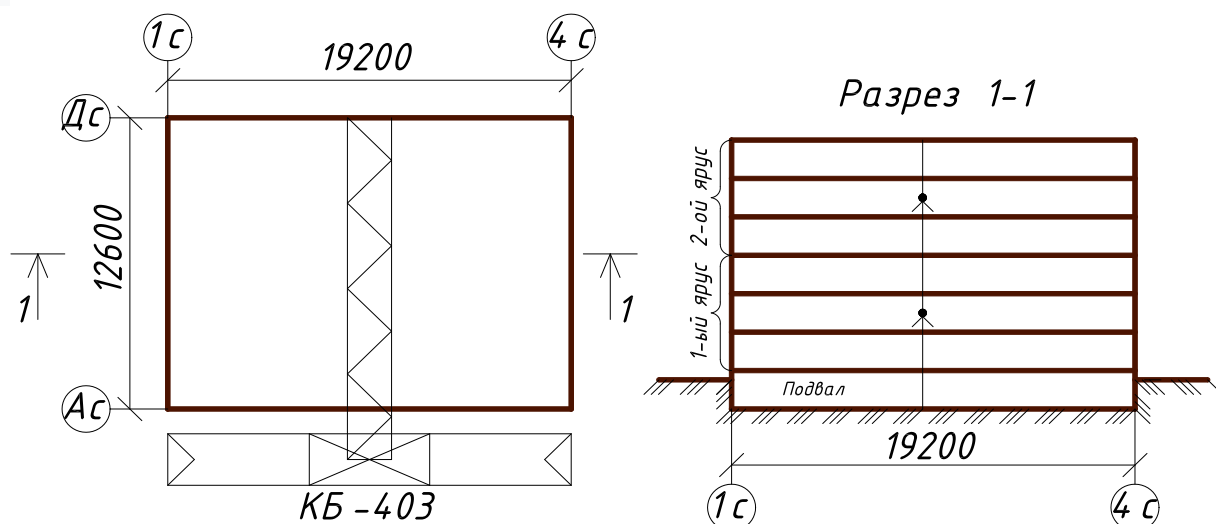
Схема выполнения монтажных и после монтажных работ строящегося жилого дома.
